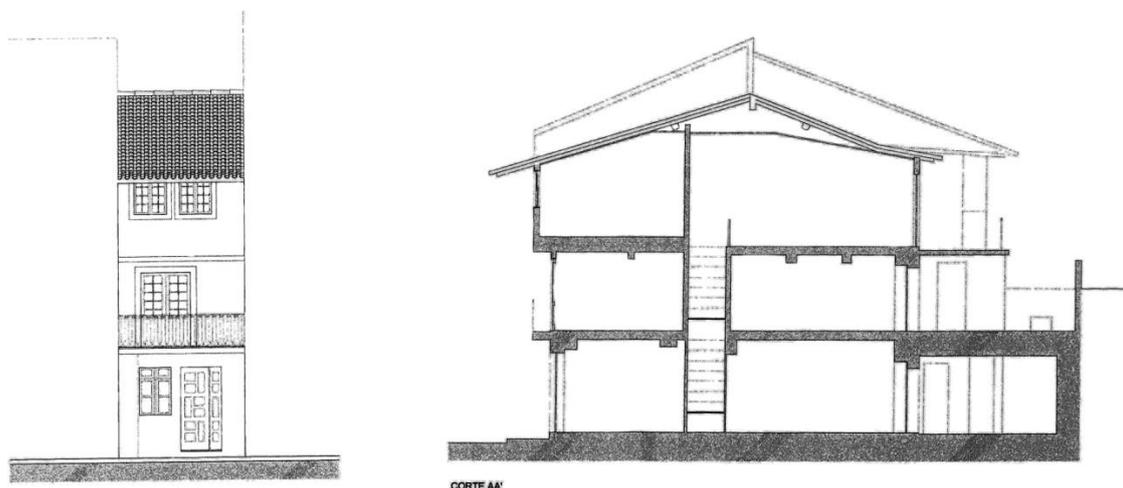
Desenhos do levantamento do pré-existente - alçado e corte longitudinal
